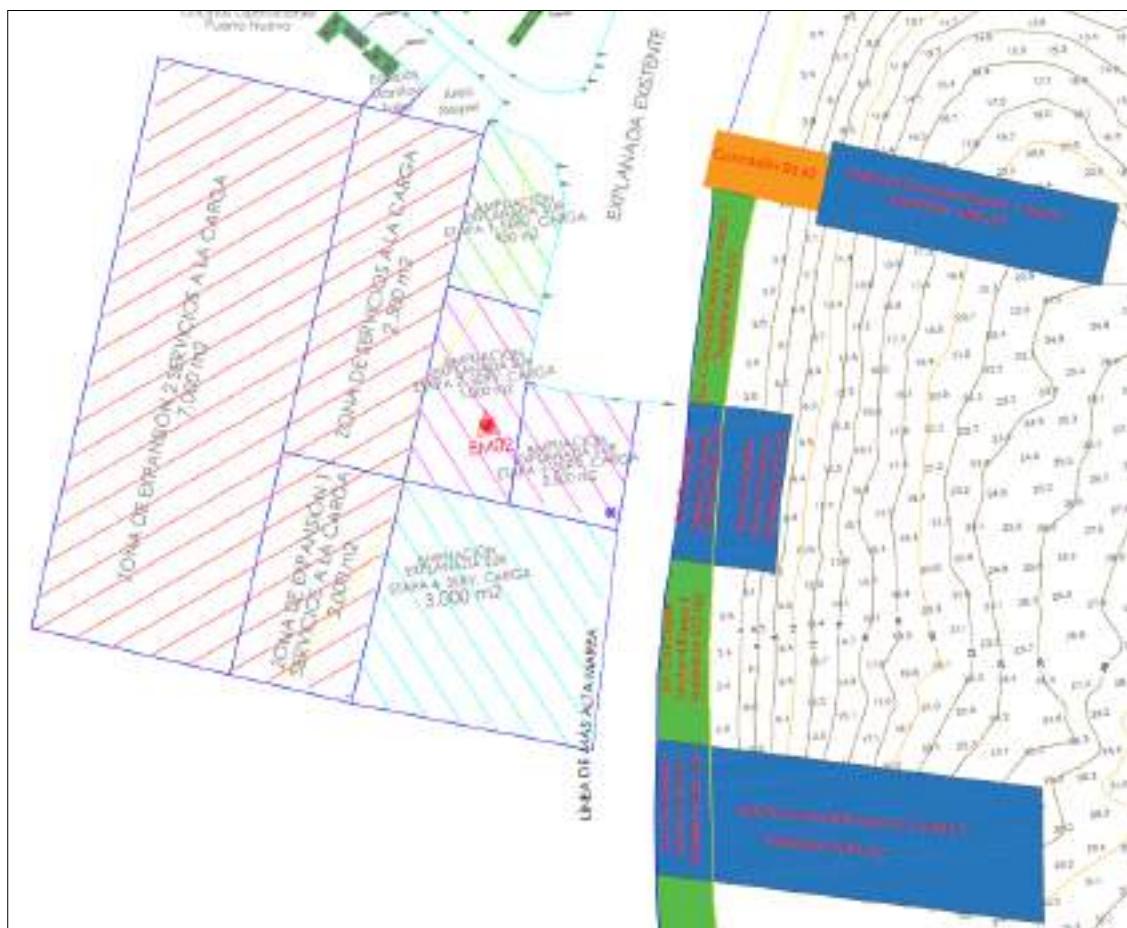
Plan de desarrollo, proyecto Puerto Nuevo
